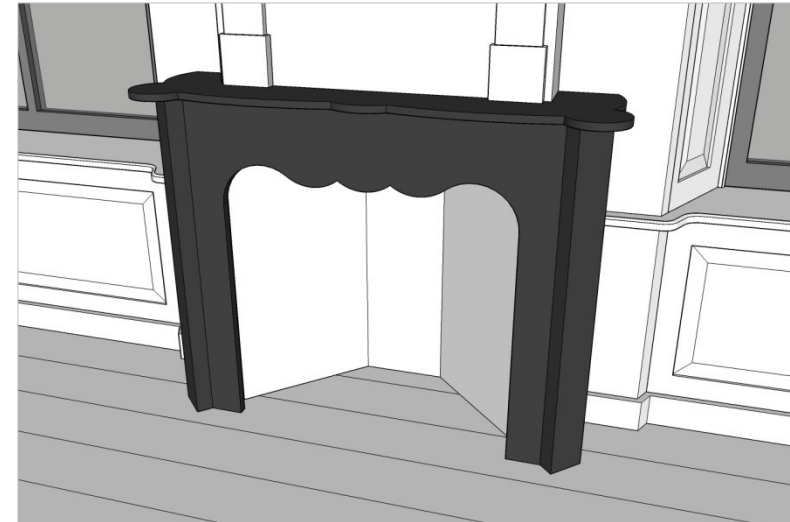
Overzichtsfoto boezem, bijv. foto (8)
